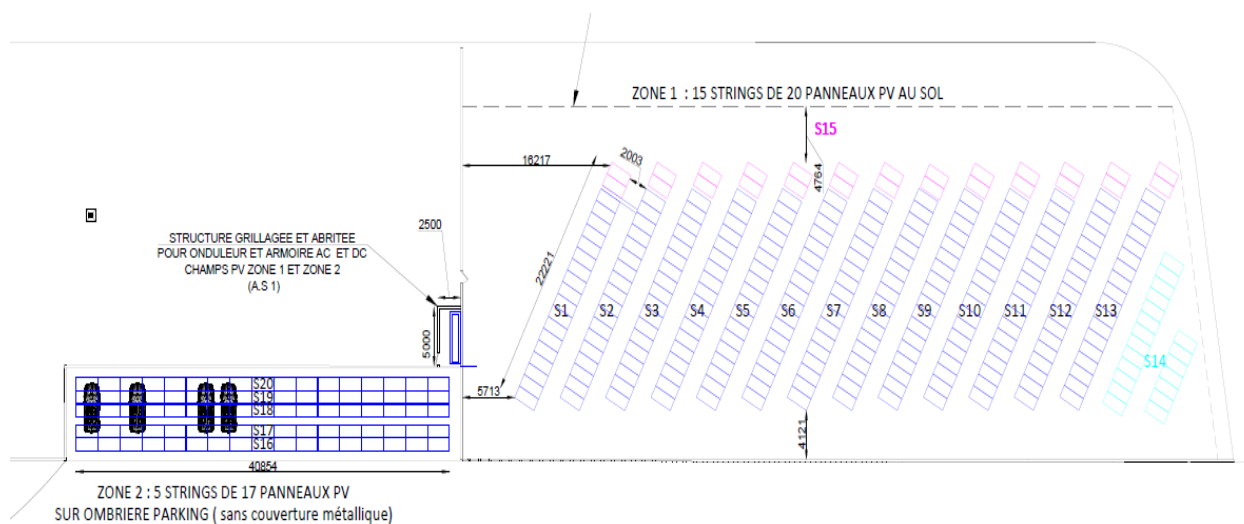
Plan d'implantation des panneaux photovoltaïques dans les zones 1 et 2 :
